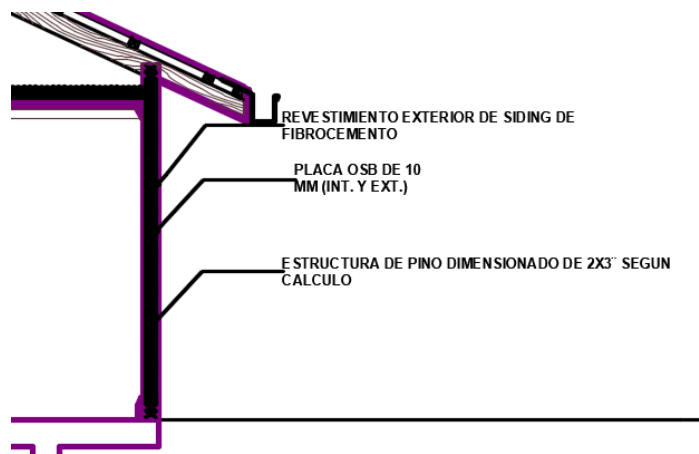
Zona 2 de muros. Extracto de planos existentes.
